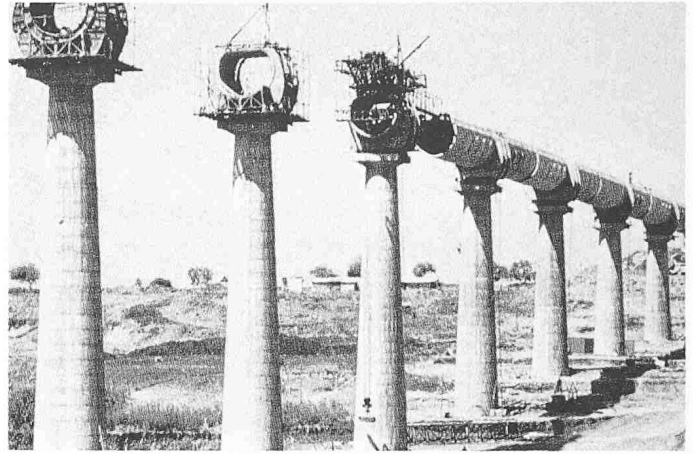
Aquädukt in Indien: Vorfabrizierte Betonelemente im Freivorbau mit Klebefugen
